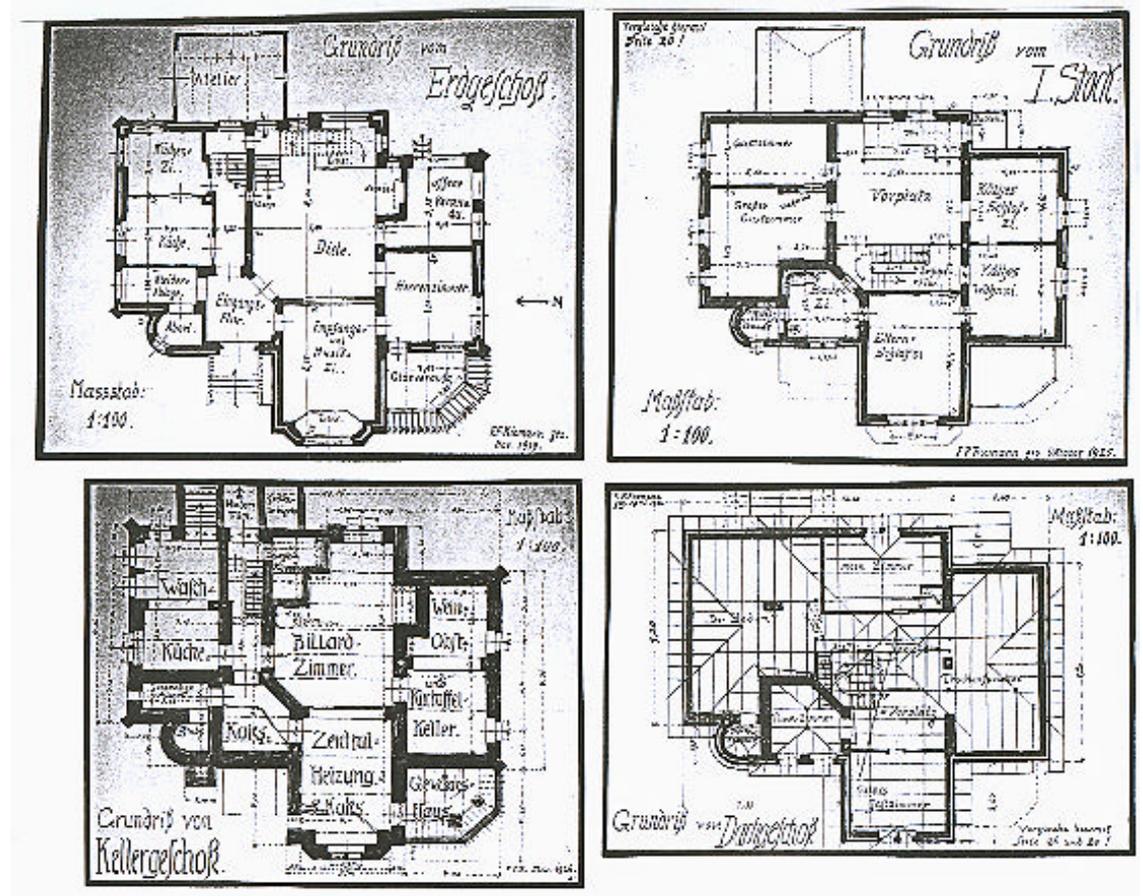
Grundrisse des Hauses Herthastraße 2
